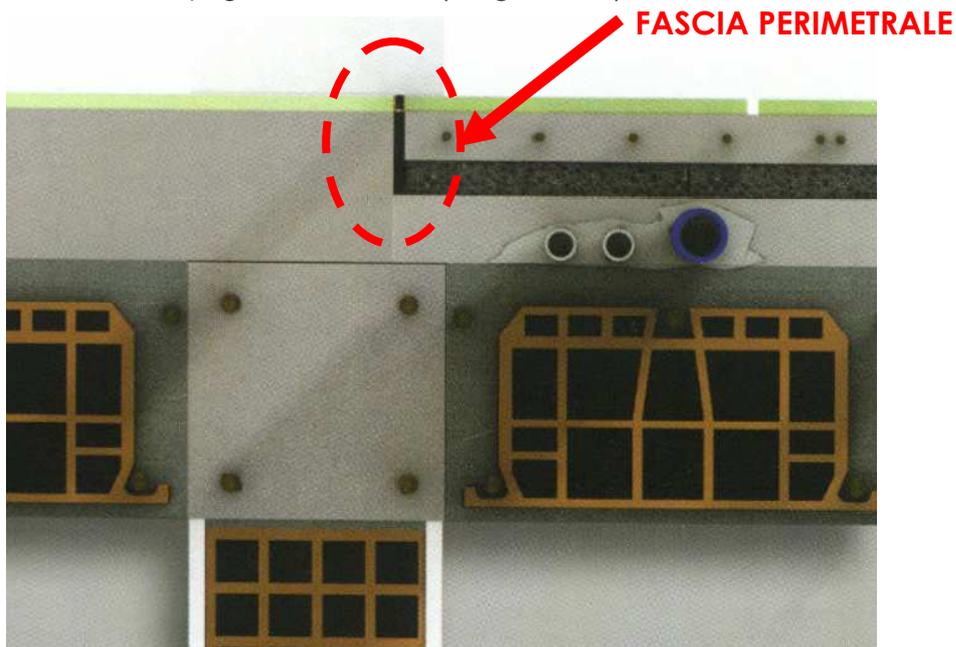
Posizionamento della fascia perimetrale che si consiglia di adottare in corrispondenza dell'attacco tra il pavimento galleggiante e il pavimento fisso
